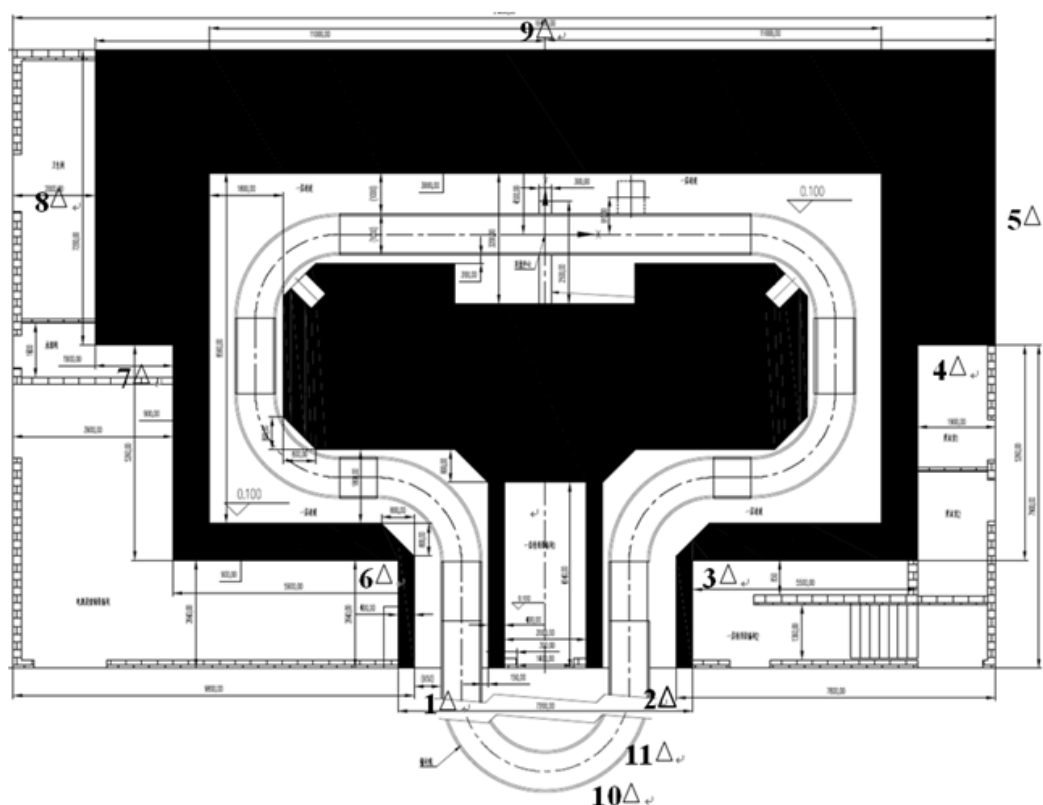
辐照加速器机房一层辐射环境监测点布置平面图
